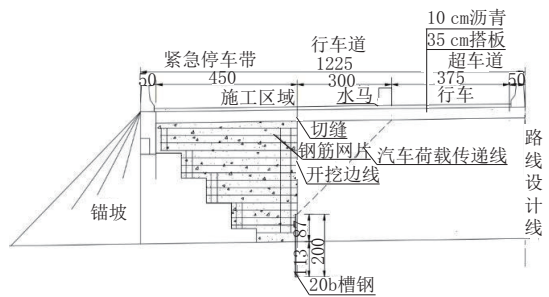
左侧轻质混凝土浇筑及配筋(单位:cm)
